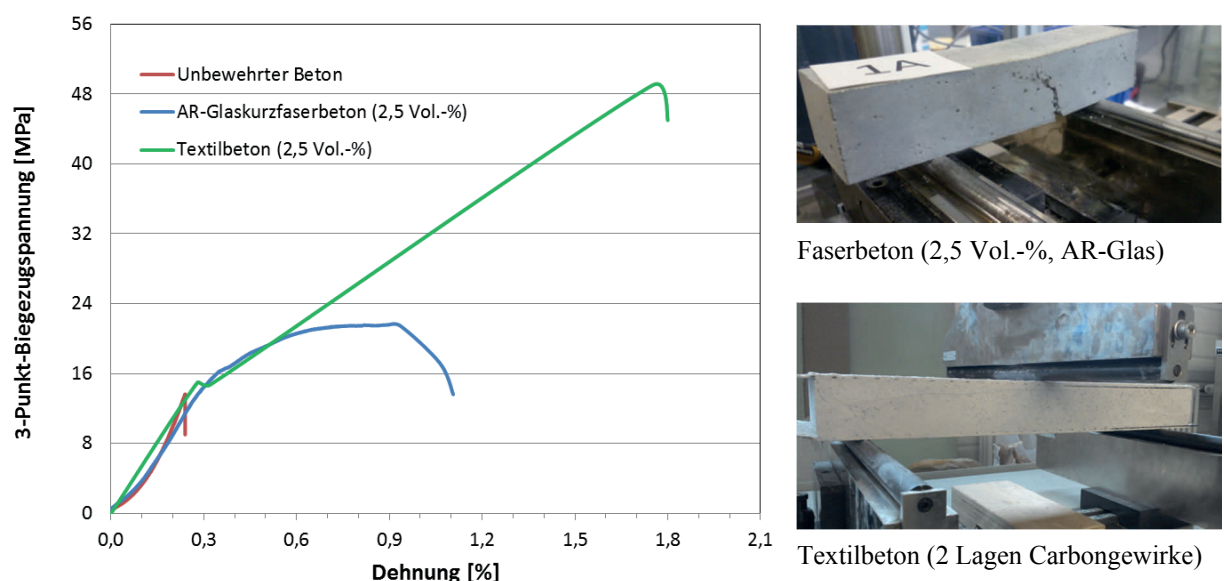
Spannungs-Dehnungs-Diagramm von unbewehrten und bewehrten Betonen (li.), Darstellung der 3-Punkt-Biegezugprüfung von Faserbeton und Textilbeton (re.)
